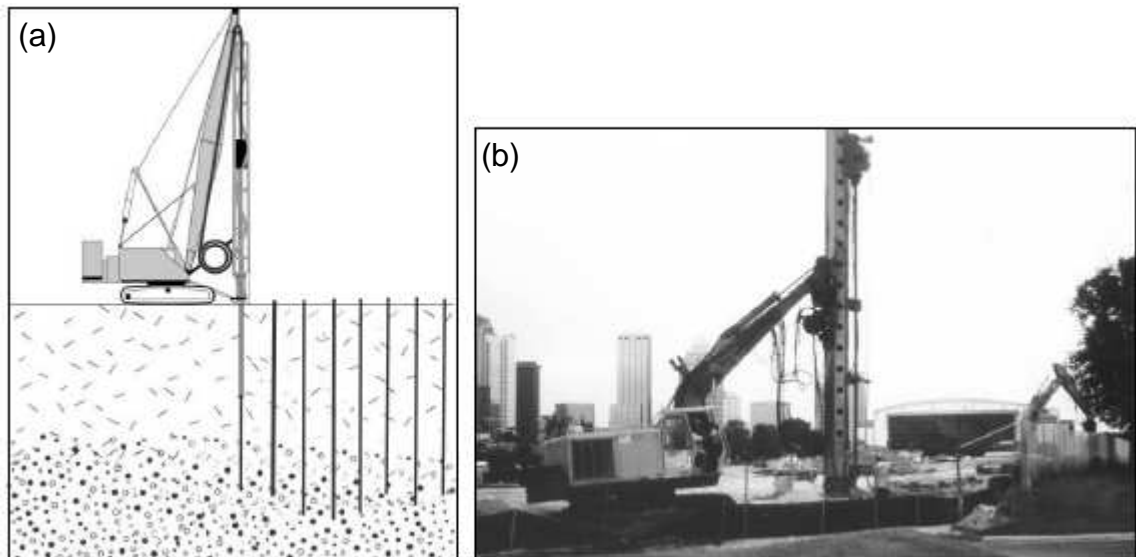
Instalação típica de drenos verticais (Fonte: JOHNSON, 1970)
